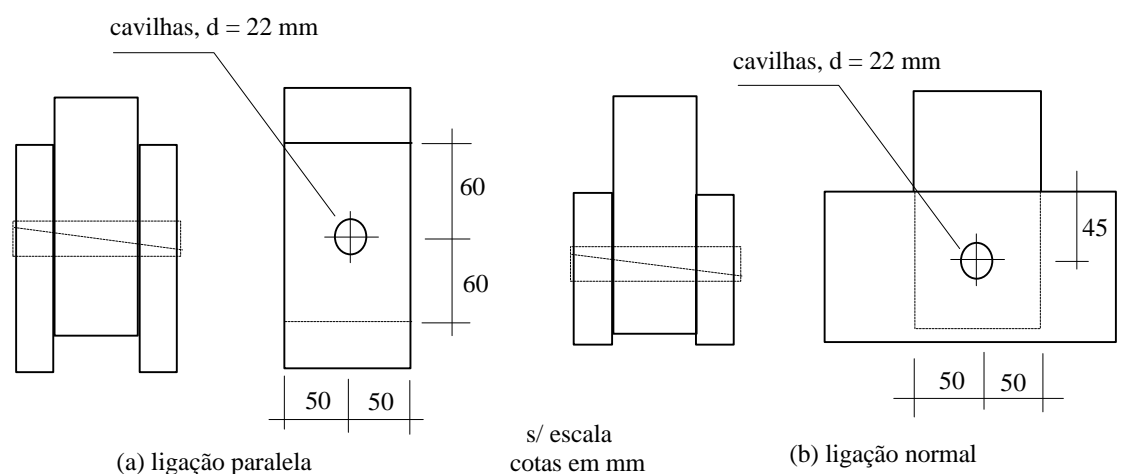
Corpos-de-Prova de Ligações Cavilhadas
